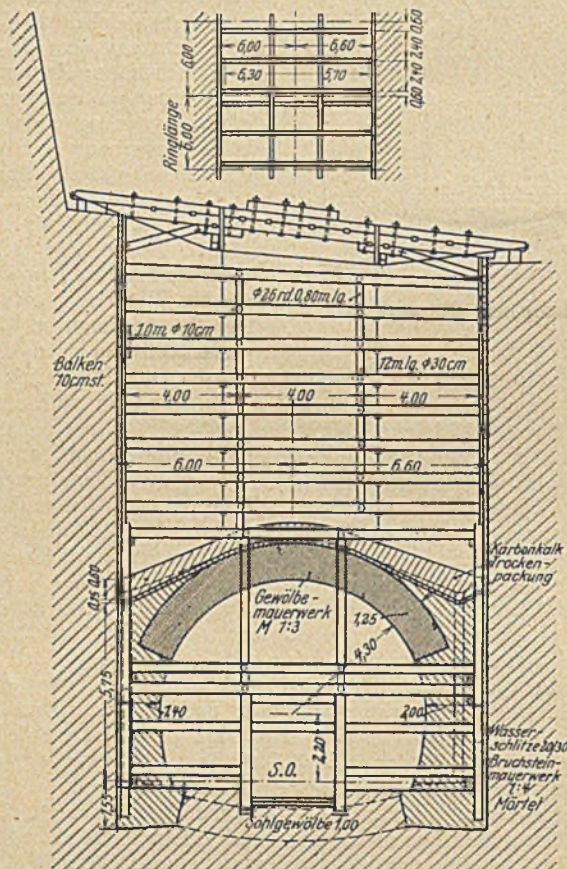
Tunnel-Querschnitt, Auszimmerung in der Tagebaustrecke.
